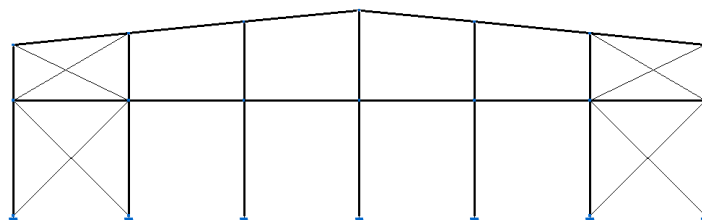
Geometría del pórtico de fachada de la nave industrial.
